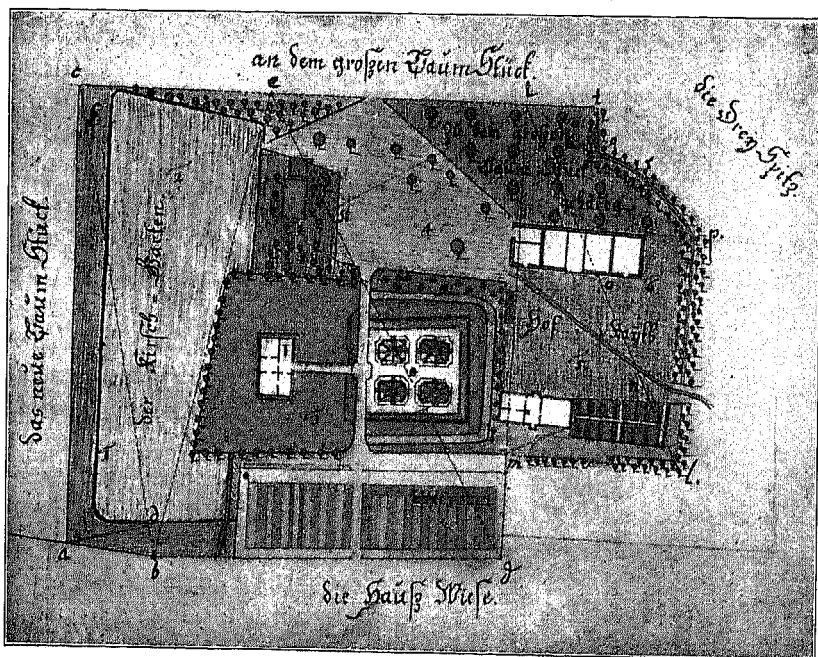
Holzhausensche Oede; Grundriss des Weiherhauses mit seiner nächsten Umgebung nach dem Steinbuche von Ph. Chr. Bunsen, 1775.
